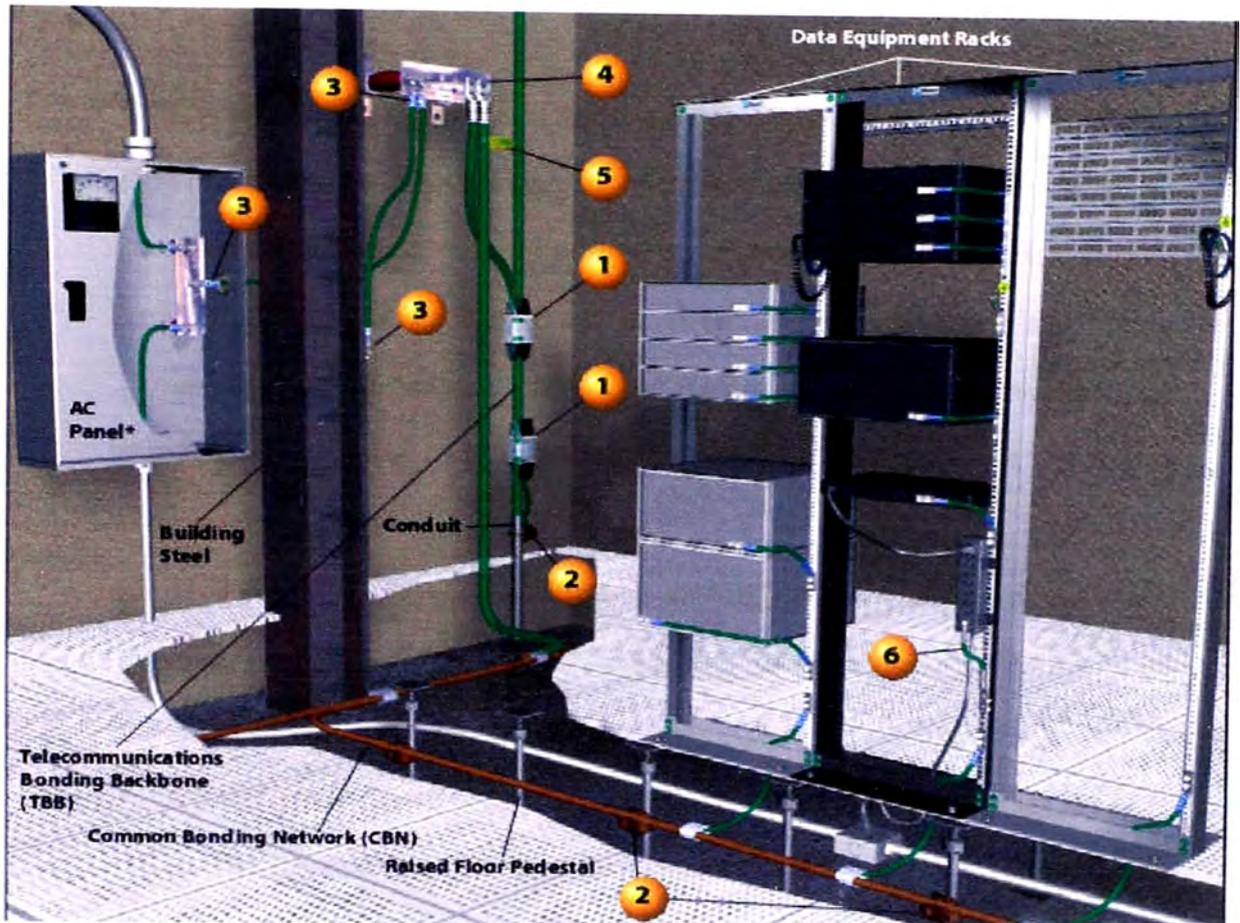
Detalles de Instalación de Puesta a Tierra
